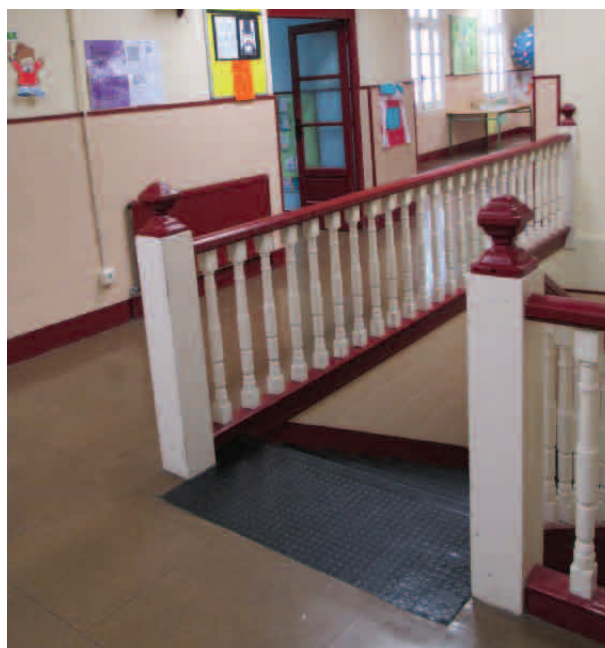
Desembarco de las escaleras entre la planta baja y la planta primera (fuente propia)
